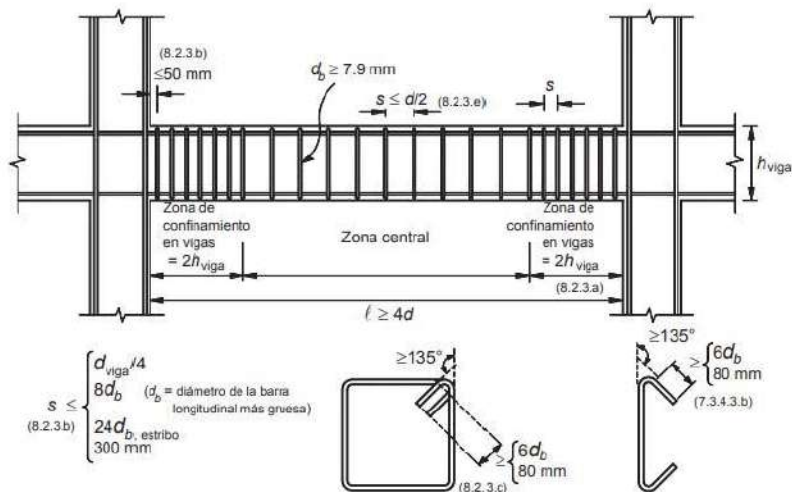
Detallado de elementos a flexión de ductilidad media
